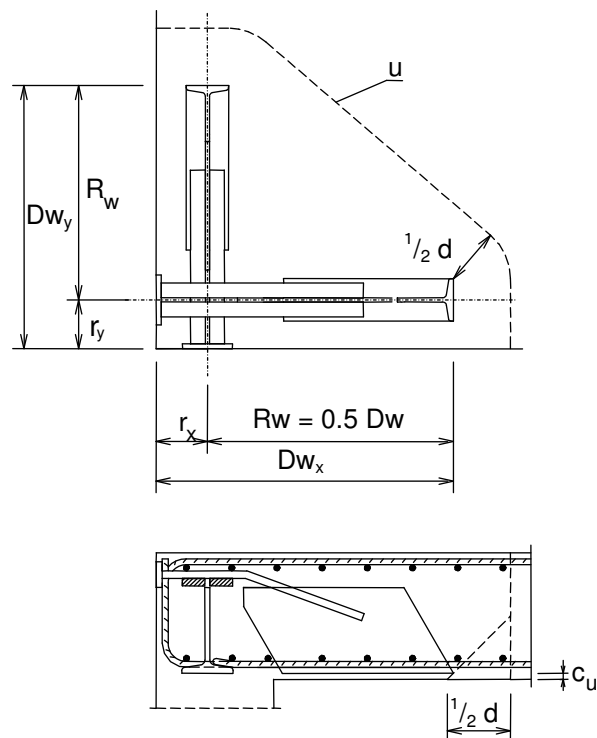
Bewehrungsführung bei Eckstützen mit dem TUCHSCHMID-WALM®
